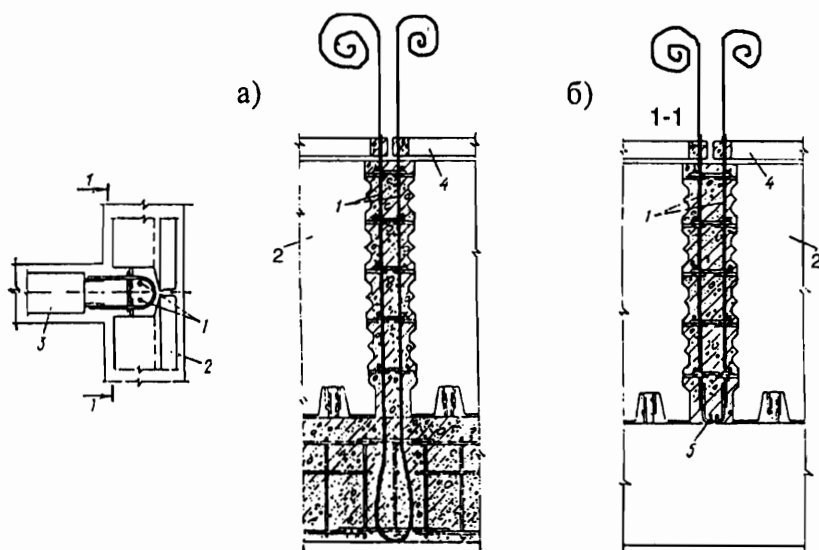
Анкеровка канатной арматуры в монолитном (а) и сборном (б) фундаментах: 1 – вертикальная канатная арматура; 2 – наружная цокольная панель; 3 – внутренняя цокольная панель; 4 – плита перекрытия; 5 – петлевой выпуск
